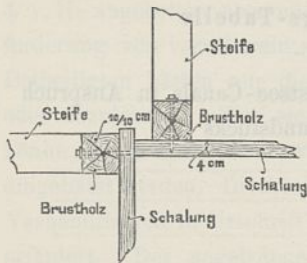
Ecke der Verschalung eines Stampfbetonbauwerks.
